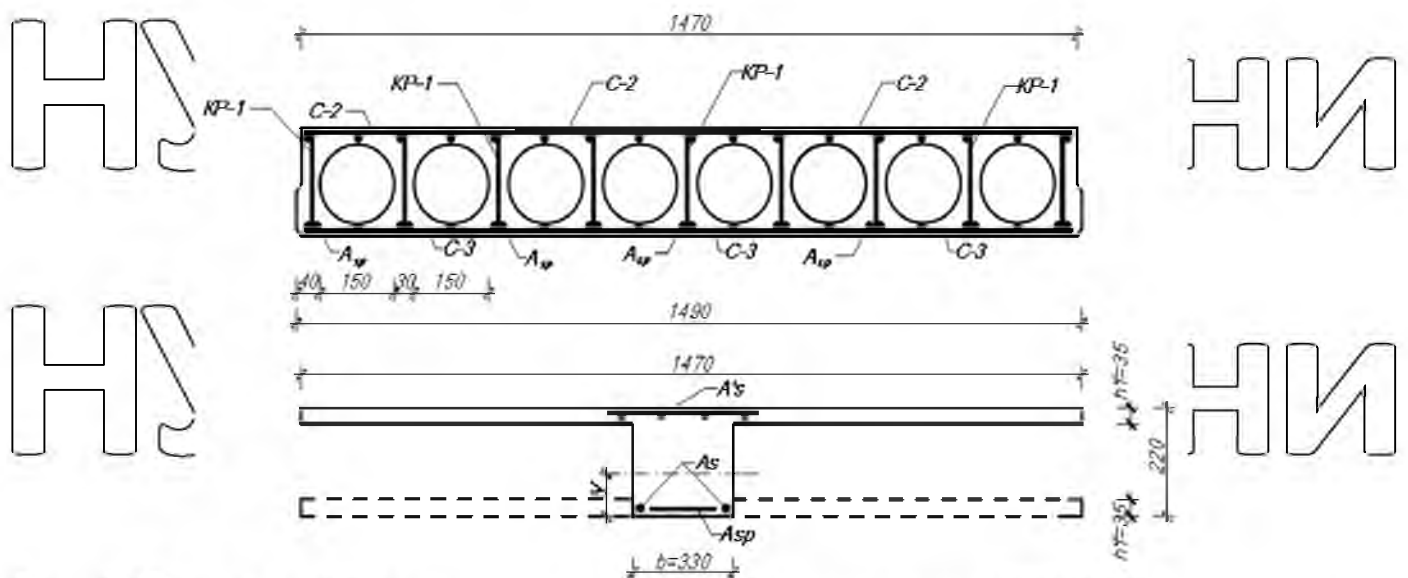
Розрахункова схема плити перекриття ПК60-1/5
